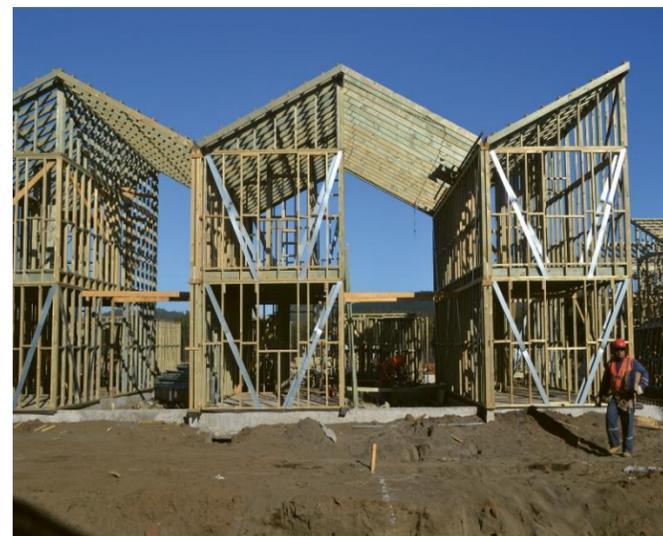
Proceso de construcción de la otra mitad de la vivienda
